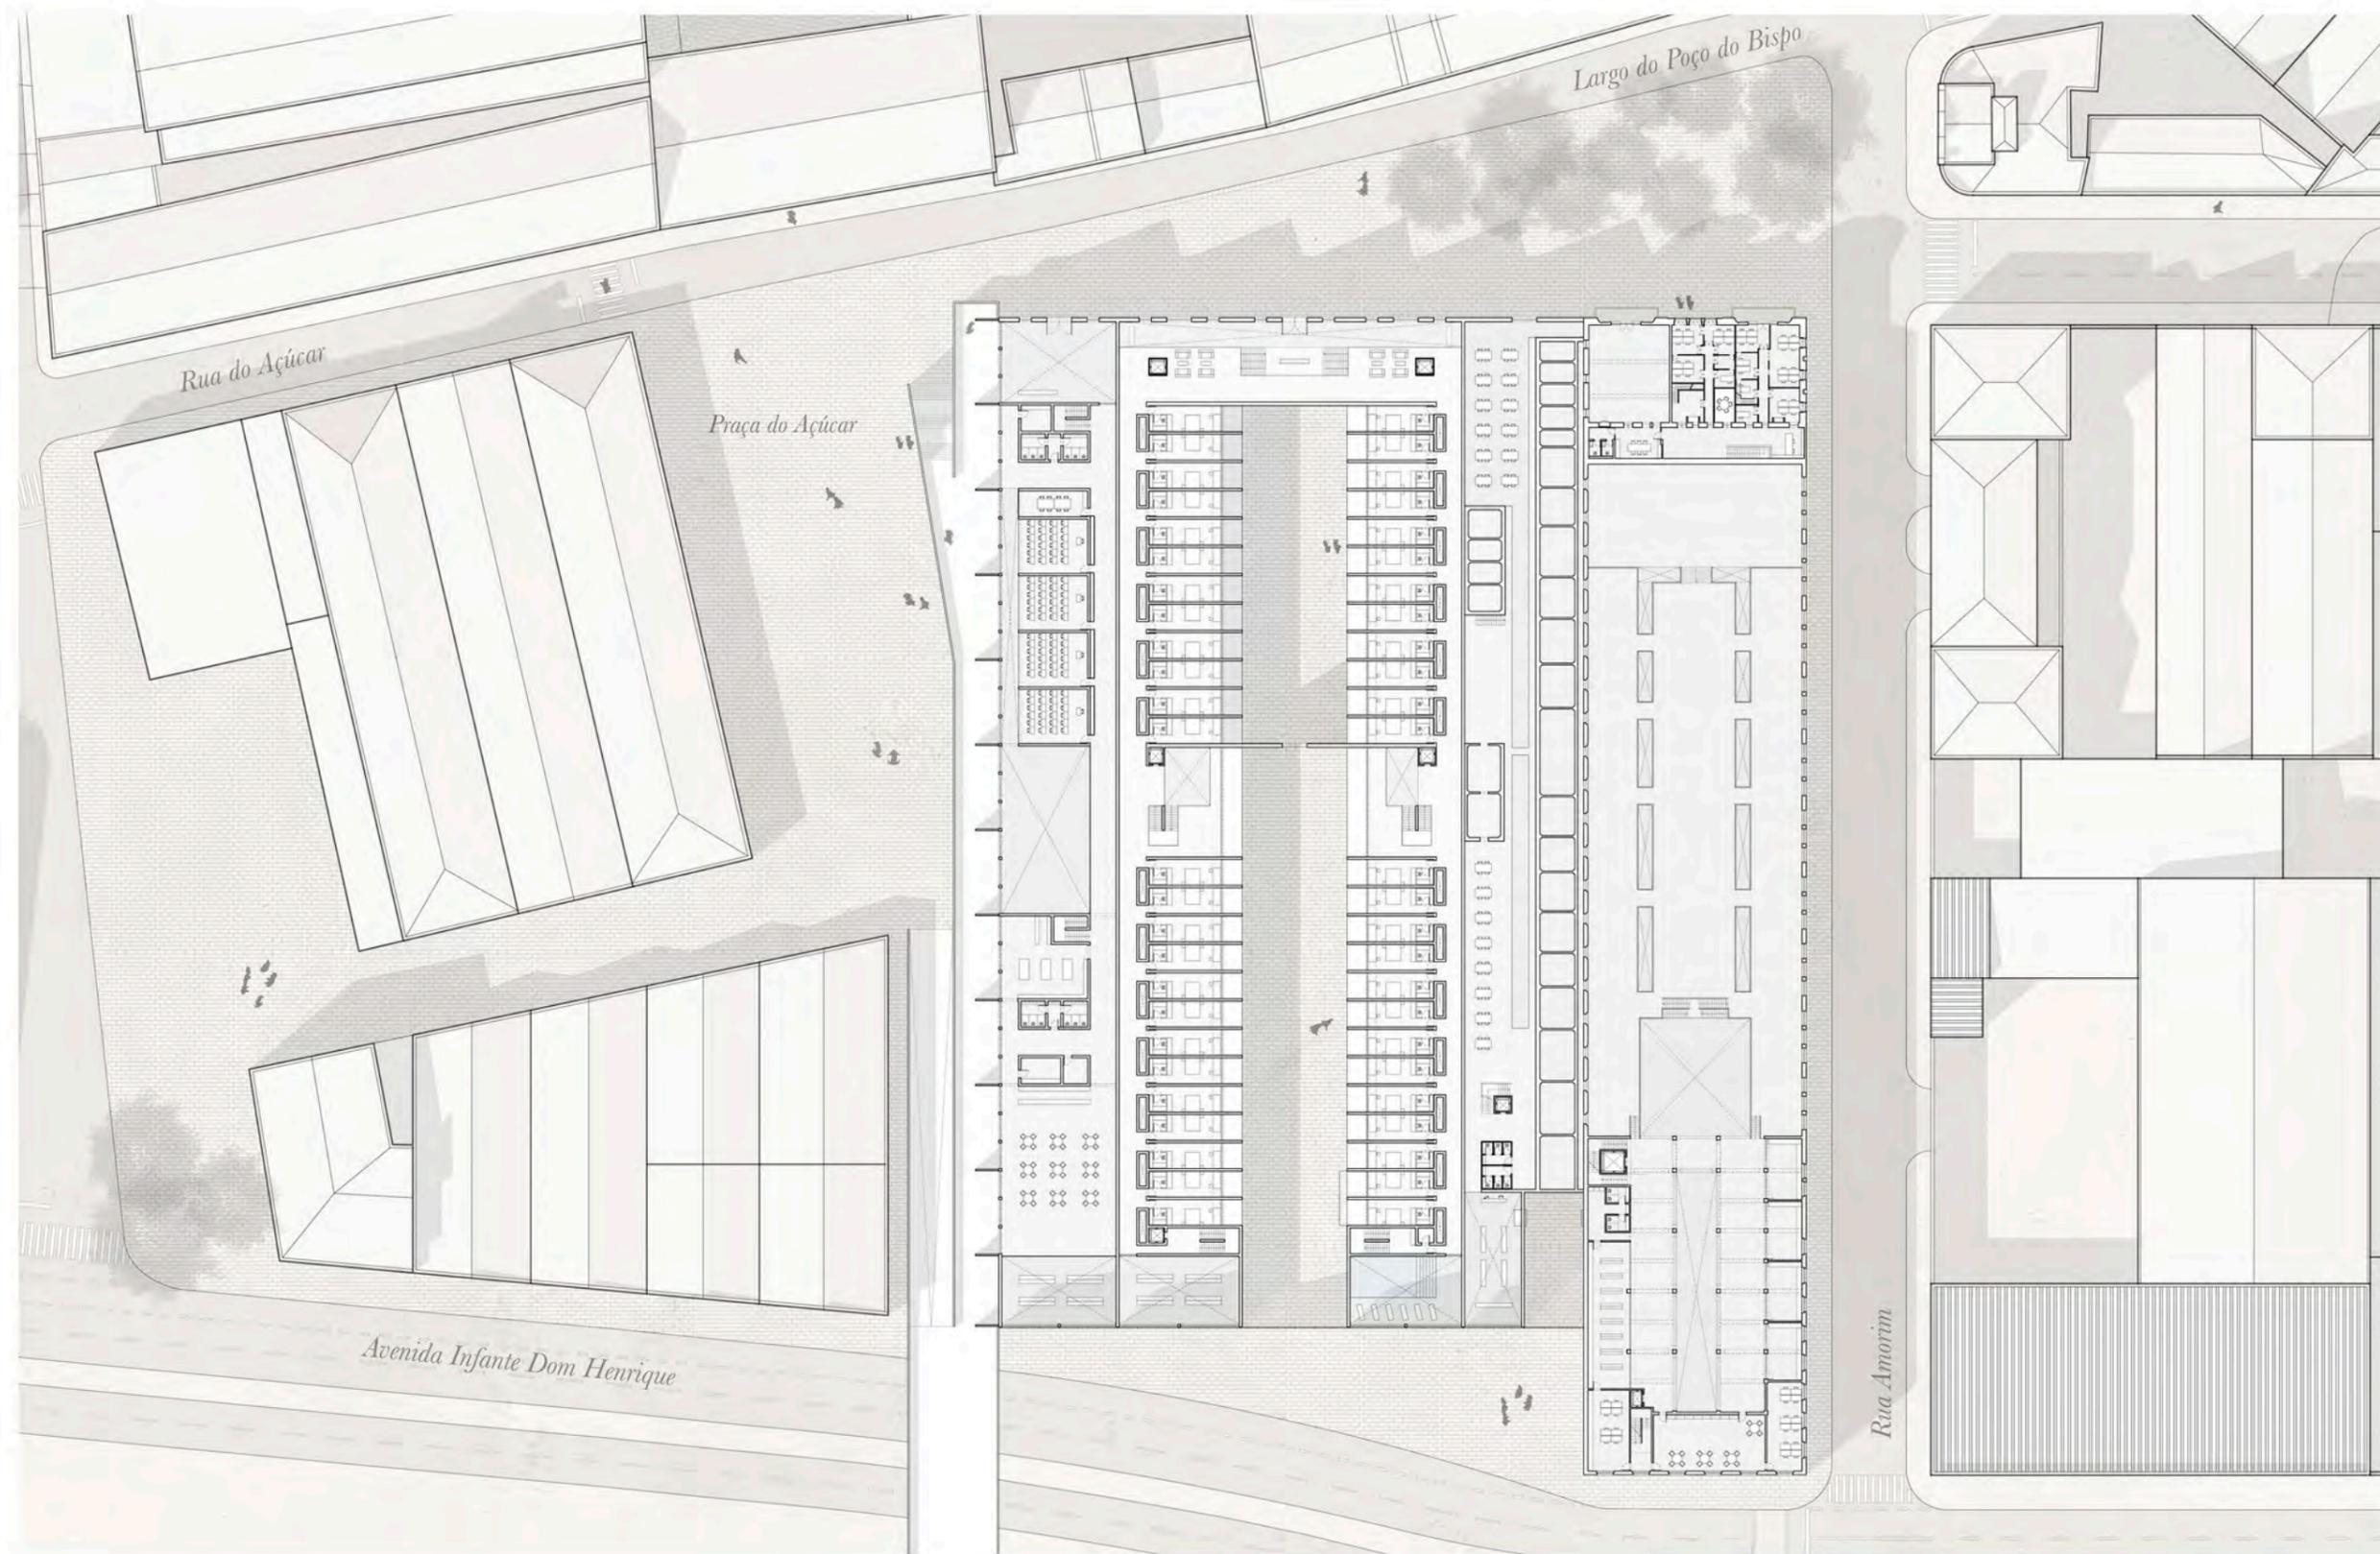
Planta do 1º piso (legenda no desenho em anexo)
